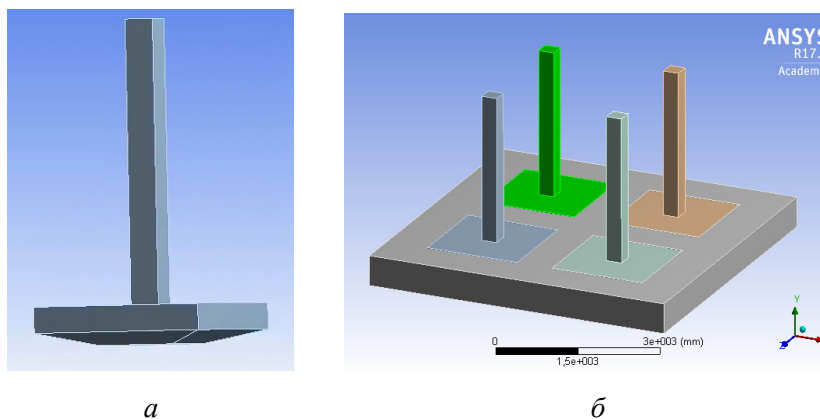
Модель двухслойного фундамента: *a* – модель фундамента сборного по патенту МПК E02D27/01 [16] с трапециевидной формой основания из бетона В30; *б* – двухслойная сборная модель фундамента (сетки армирования располагаются аналогично модели 2)
